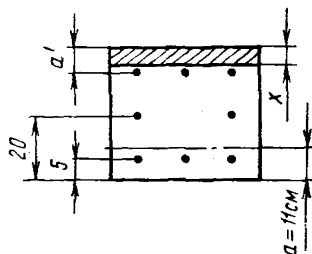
Сечение железобетонной сваи для расчета на изгиб.
